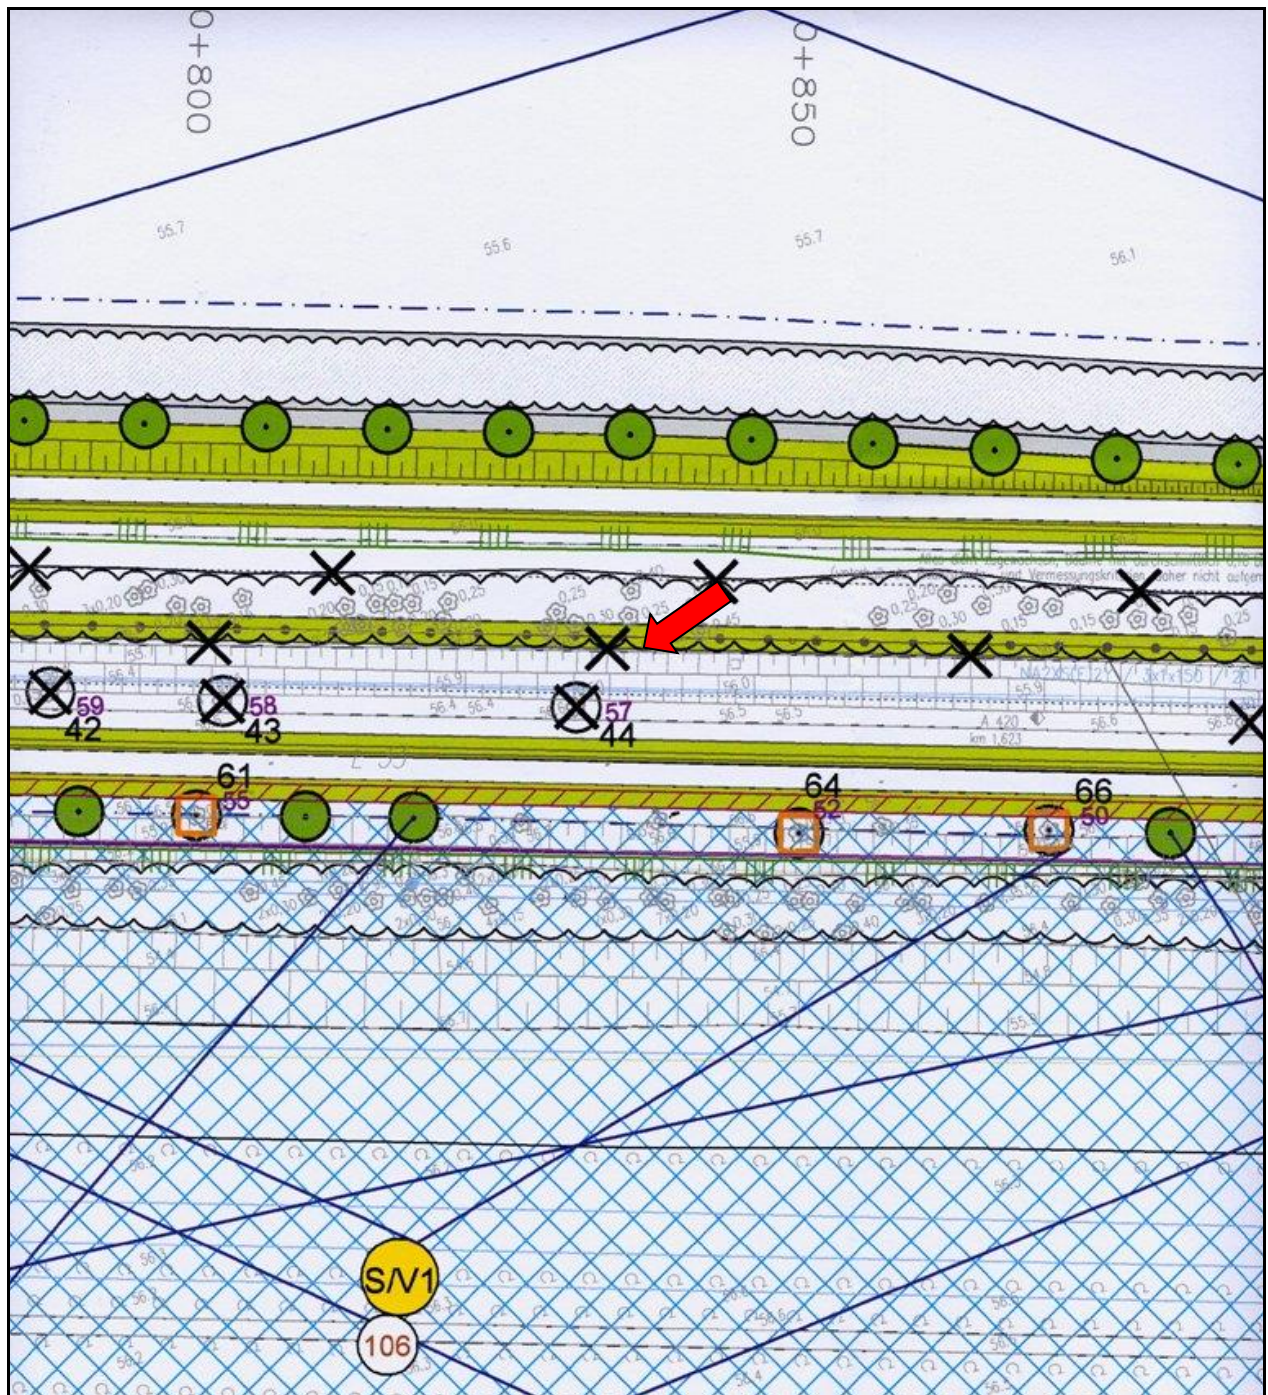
Lageplandarstellung des 1. Horstbaumes (Mäusebussard). Der Baum steht etwa bei Bau-km 0+835, links (s. Pfeil).
